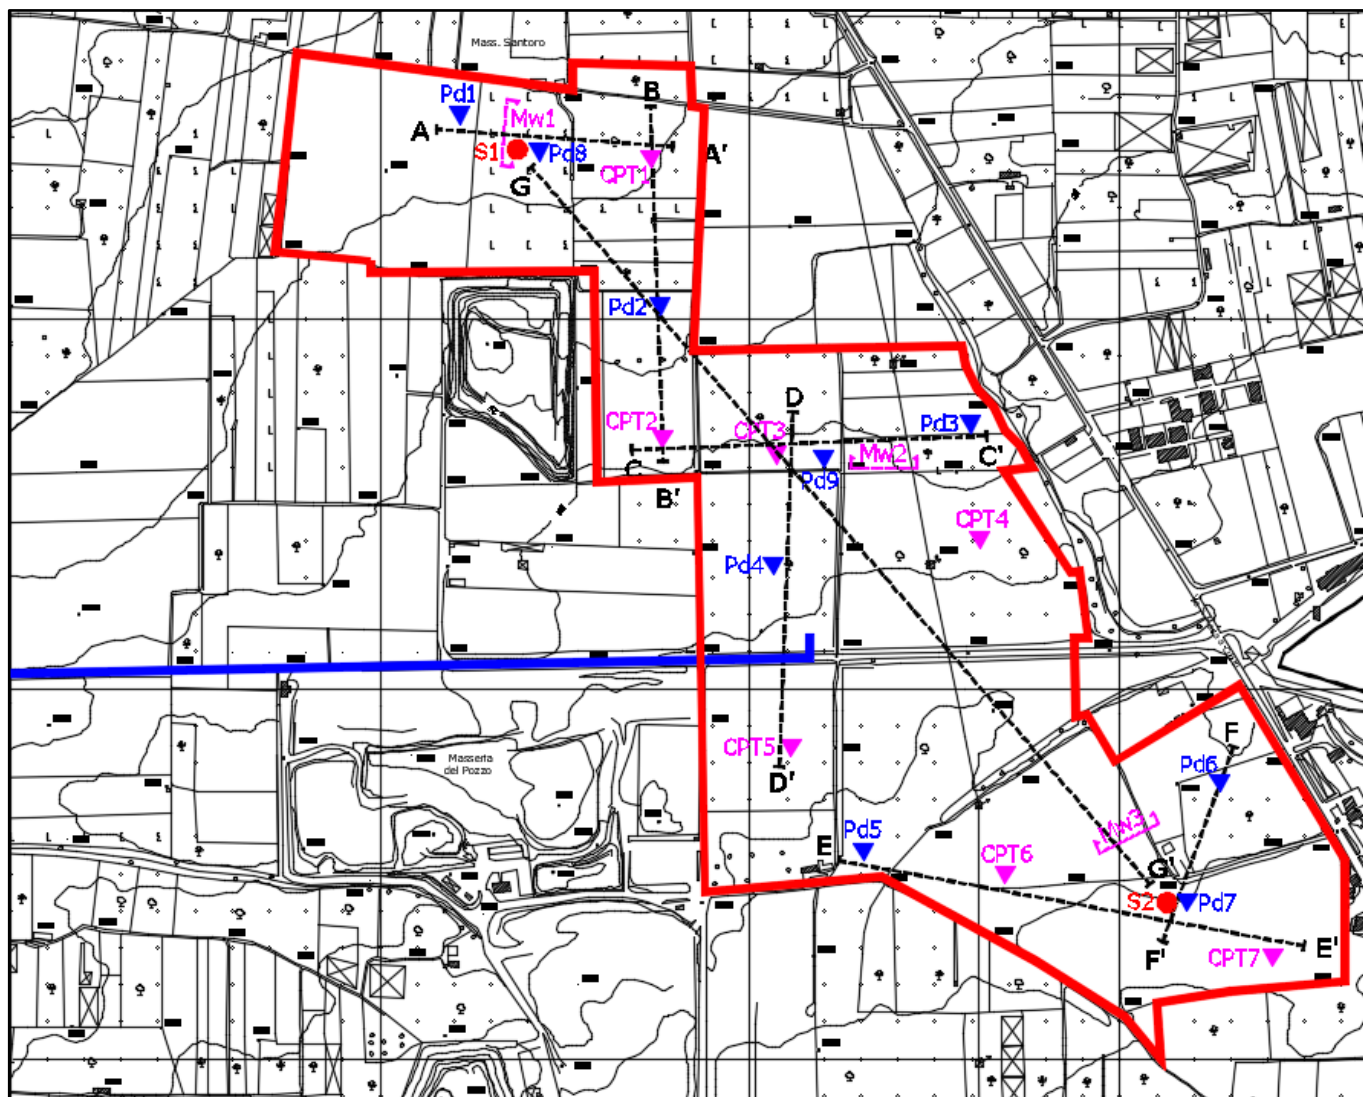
Planimetria di ubicazione delle indagini in sito eseguite presso il Campo 1 Nord
